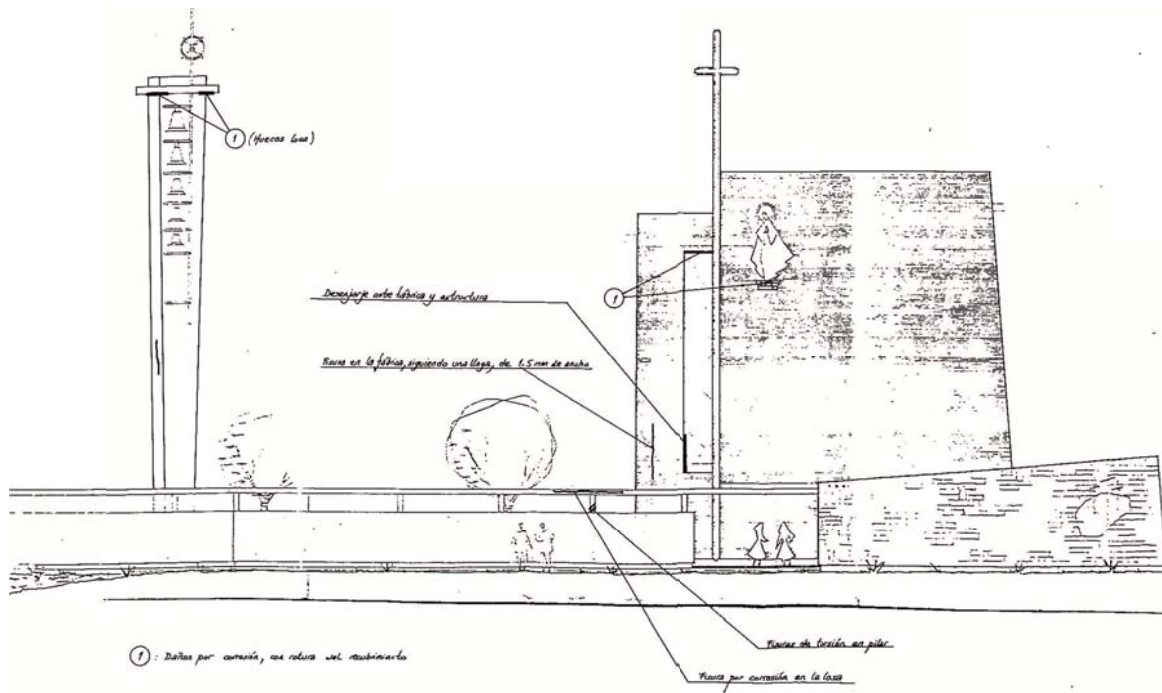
Croquis daños Fachada Sur (Fernández, J. 1999)
